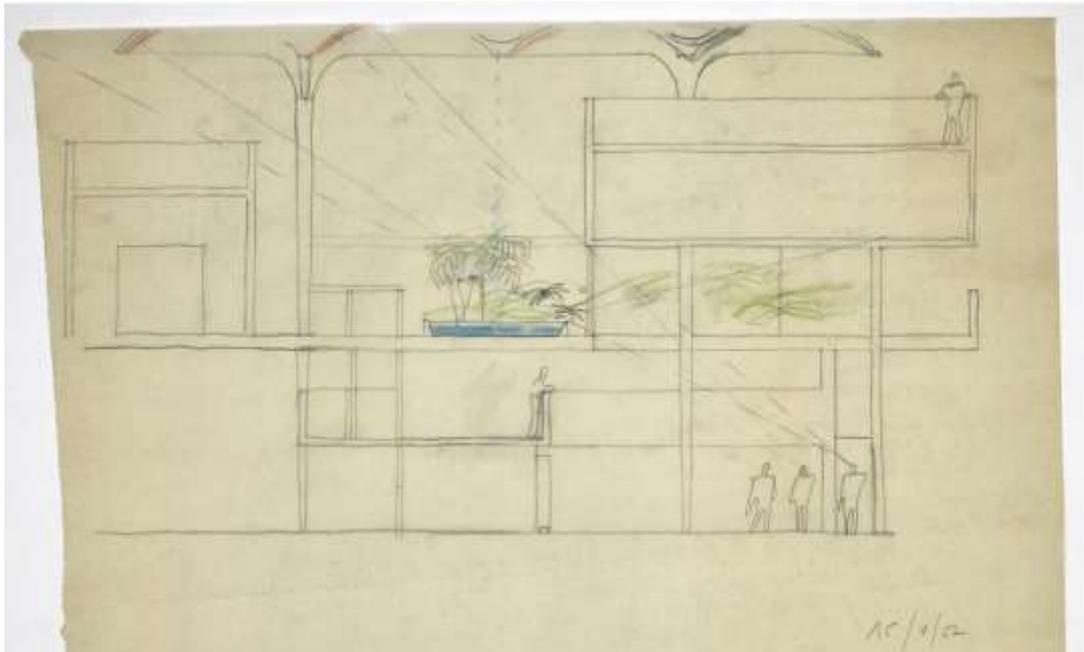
Le Corbusier, Coupe de la villa Shodhan, 6507
